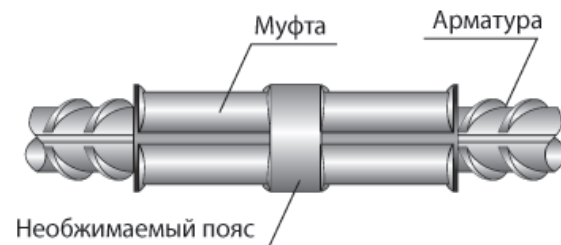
Механическое соединение арматурных стержней, выполненное многоразовым поперечным деформированием соединительной муфты без промежутков
